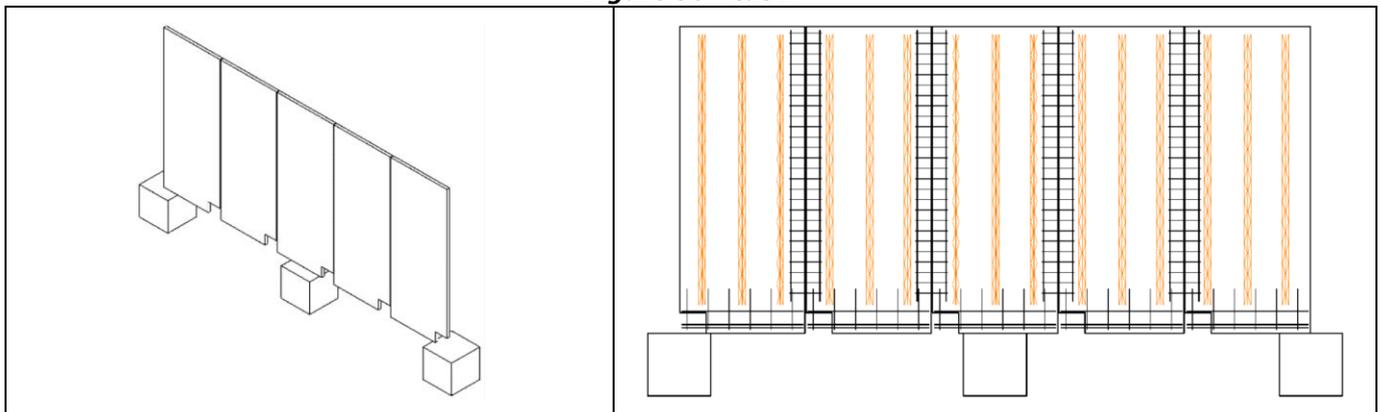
Liaison encastrée avec aciers 2^e face sur chantier
